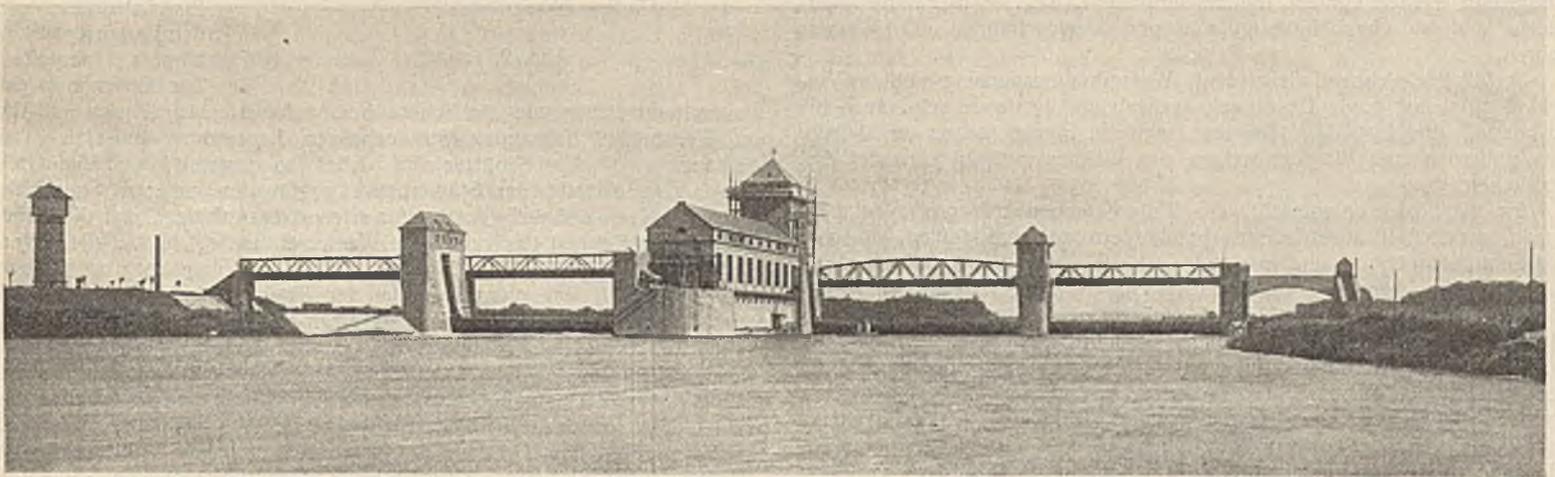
Wehranlage Kesselstadt im Main. 1 Walze 1. W. 40,00 m, H. 4,24 m. 2 Walzen 1. W. je 30,61 m, H. 3,44 m.
